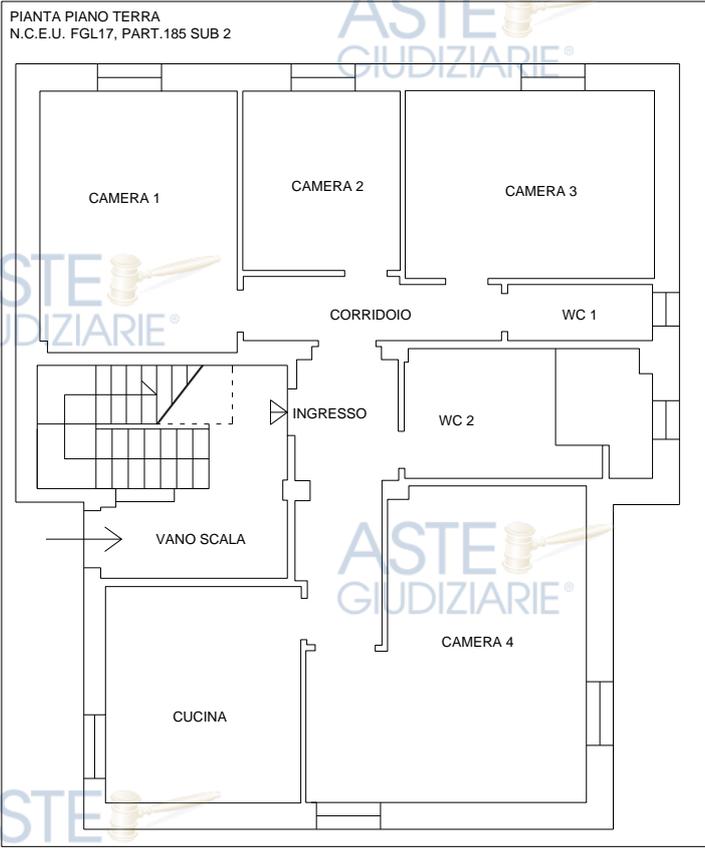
Pianta rilevata dell'immobile distinto al foglio 7/Part.185/Sub 2. Piano Terra.
